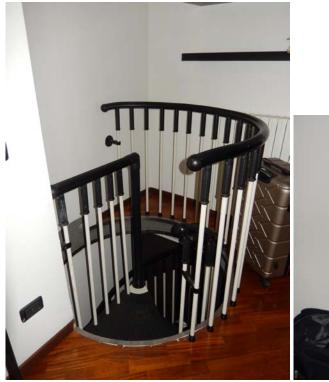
Interno dell'unità pignorata – Vista di maggior dettaglio della scala a chiocciola.
